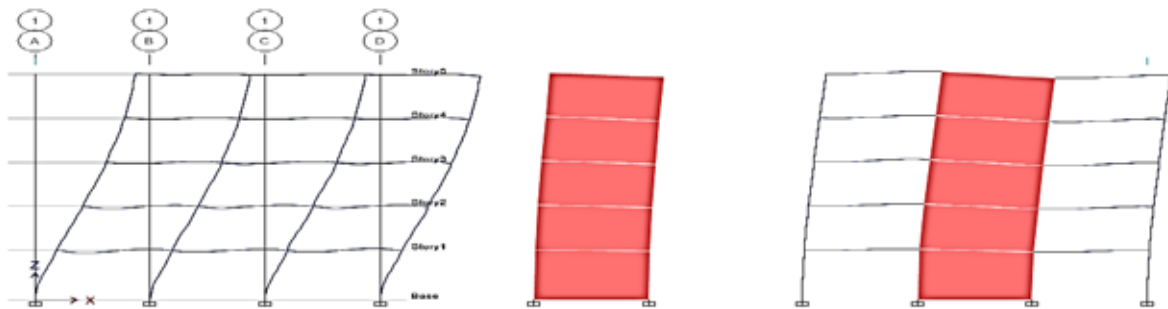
Desplazamientos de estructuras a) aporticadas, b) con muros estructurales y c) mixtas
